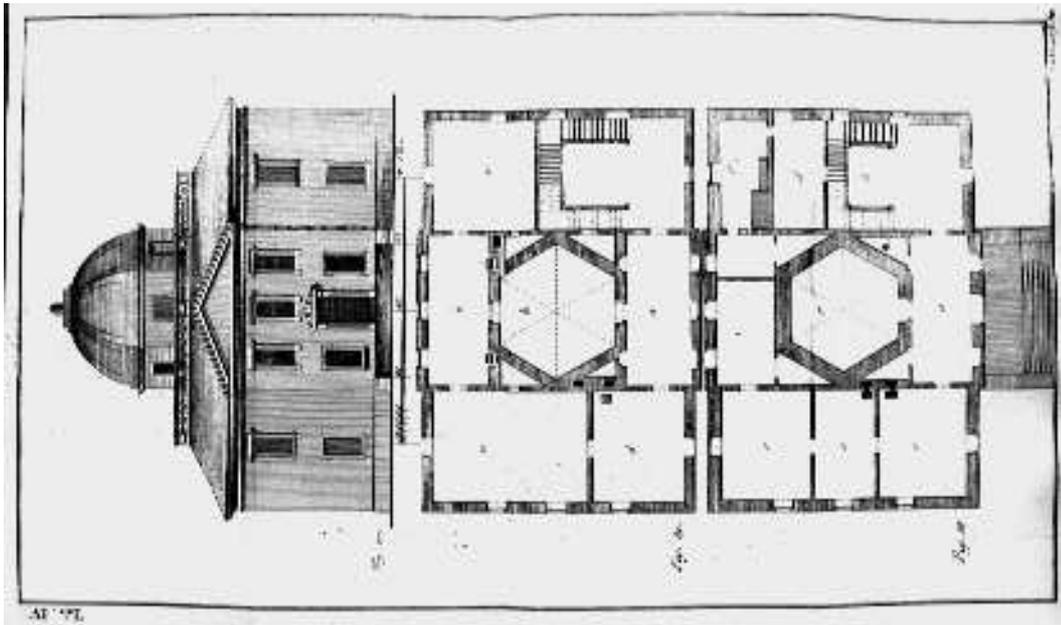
Stieglitz, Öffentliche Bibliothek, Aufsicht und Grundrisse, 1792
